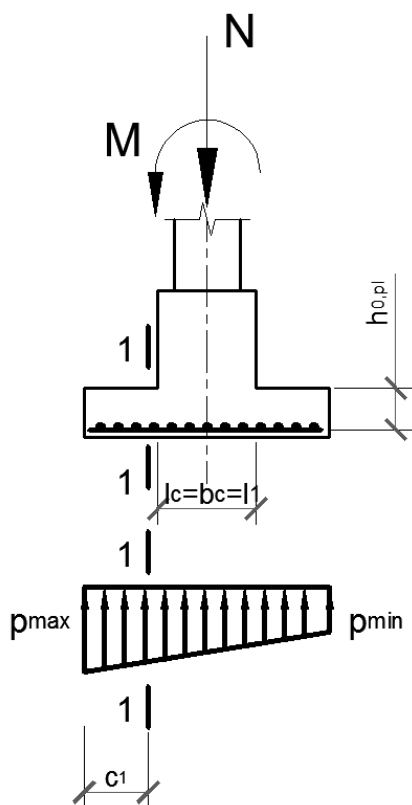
Расчетные схемы и сечения при определении арматуры внецентренно нагруженного фундамента при действии изгибающего момента в одном направлении.
